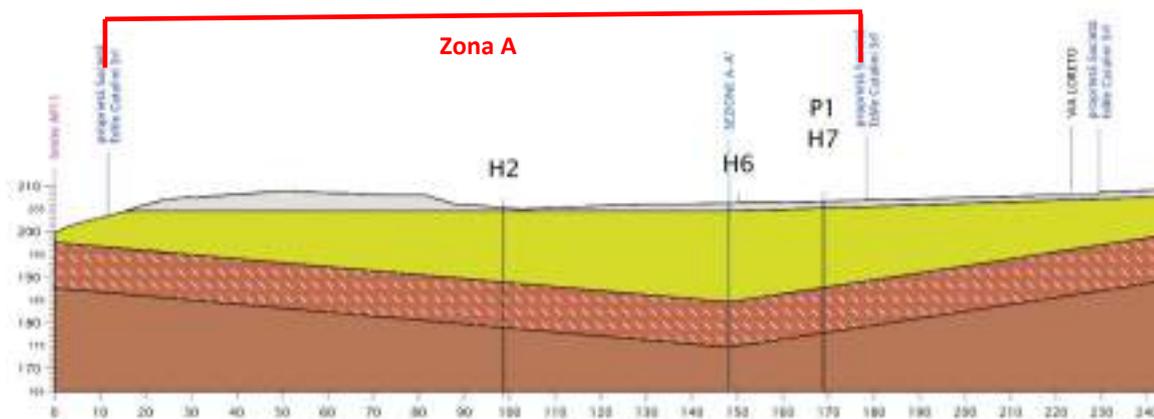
ubicazione ZONA A su STRALCIO SEZIONE LITOTECNICA B-B: da Sud-Ovest in direzione di Nord-Est.
